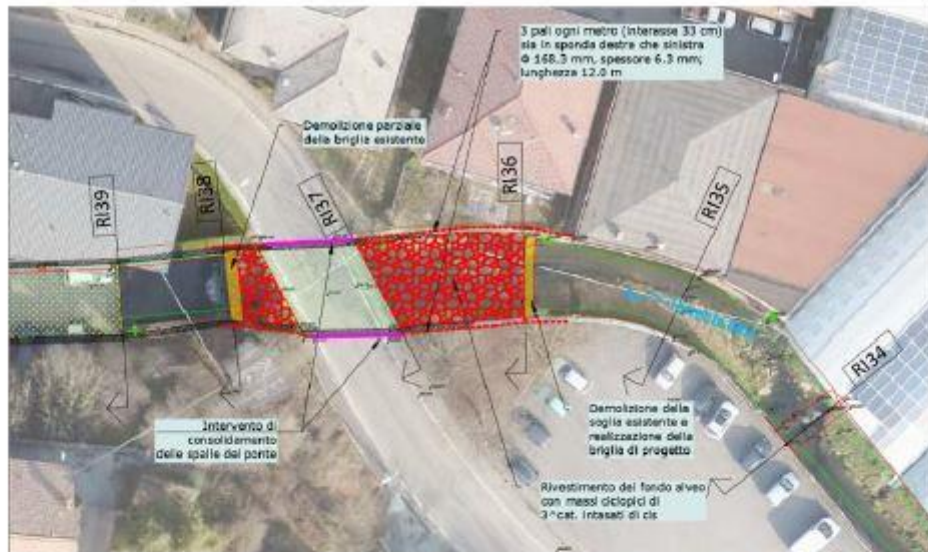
Stralcio planimetrico con indicazione degli interventi in progetto
